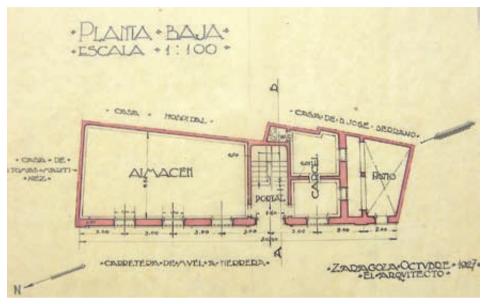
Planta baja del anteproyecto de ayuntamiento de Aguilón, 1927 (A.D.P.Z.).
